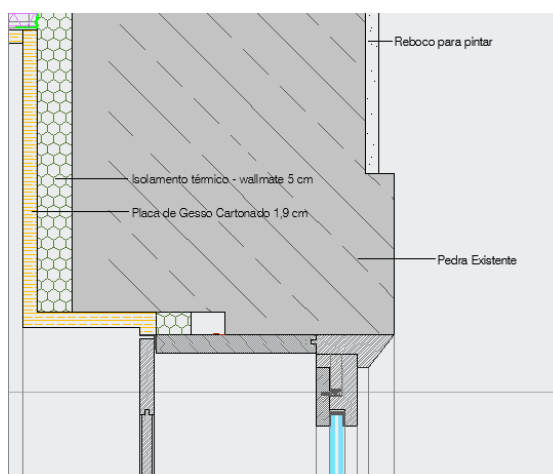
Pormenor construtivo da parede exterior da fachada (Fonte: Porto Vivo, SRU)
